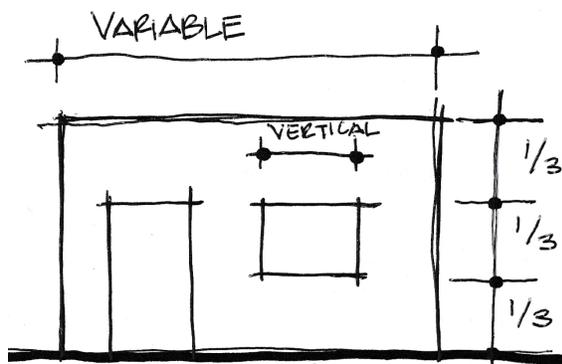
Patrón Barrio Santa Marta tipo 2. El patrón de diseño formal mas repetido en la zona a intervenir. Fuente : propia. Elaboración: propia.
